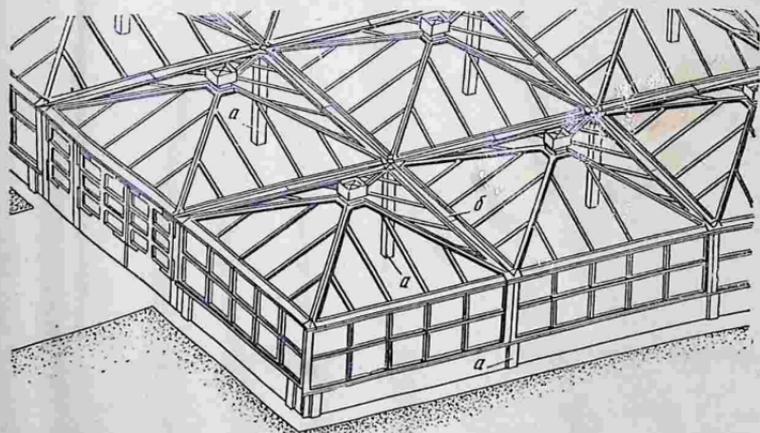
Общий вид железобетонной сборной шатровой теплицы:
